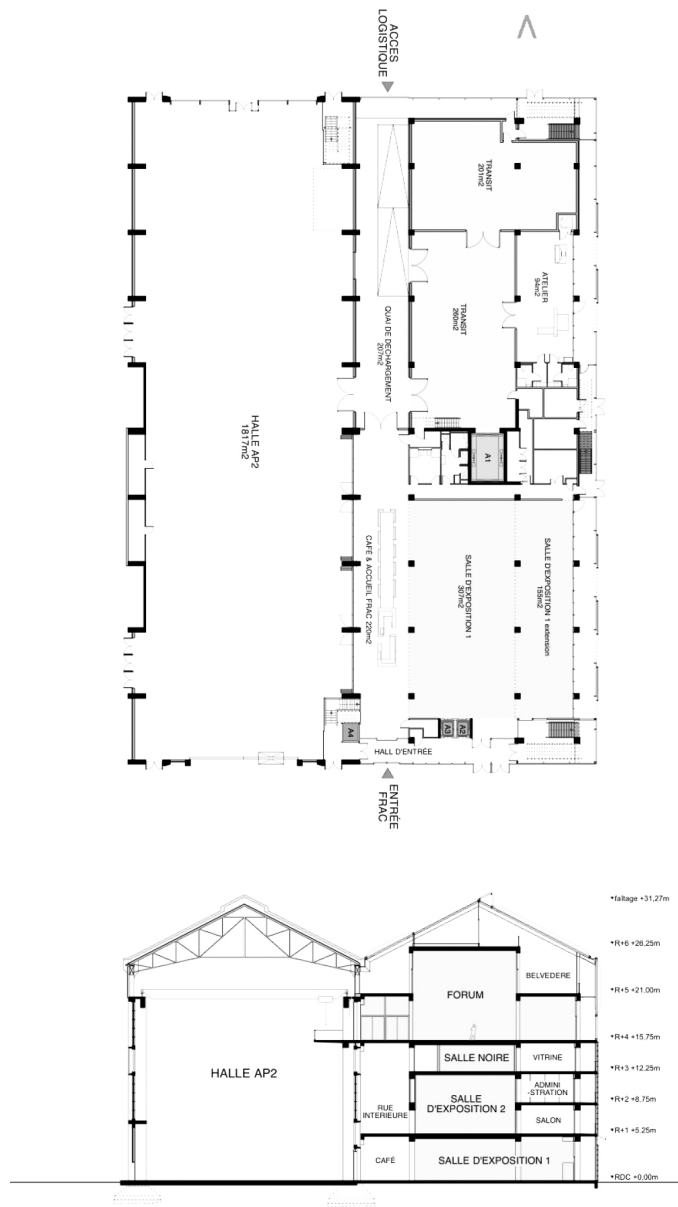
Planimetría de edificio FRAC planta y sección e isométricas
